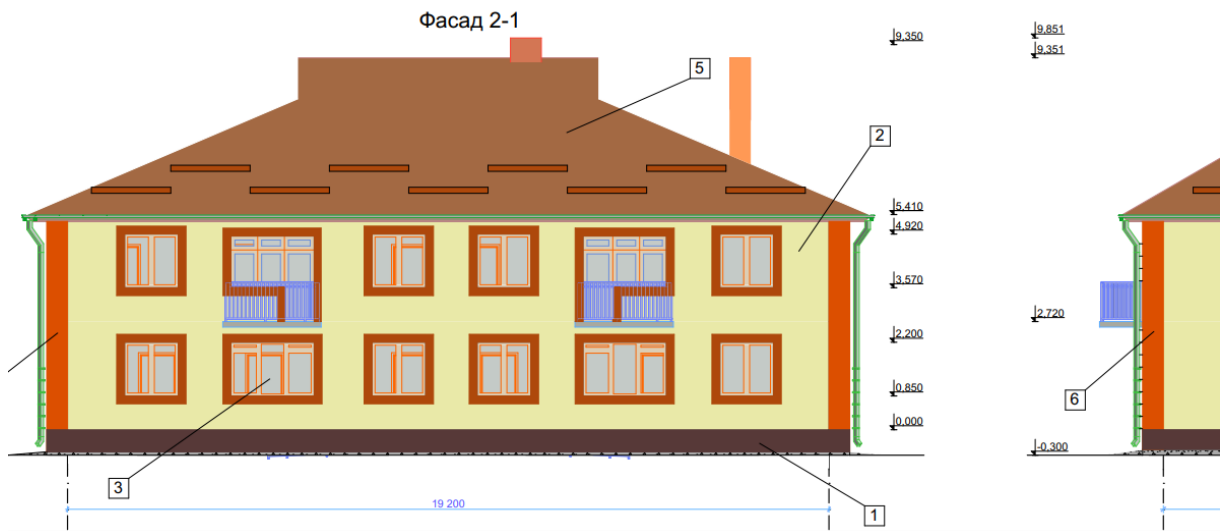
Фасад 2-1 та вигляд зліва по осі В
